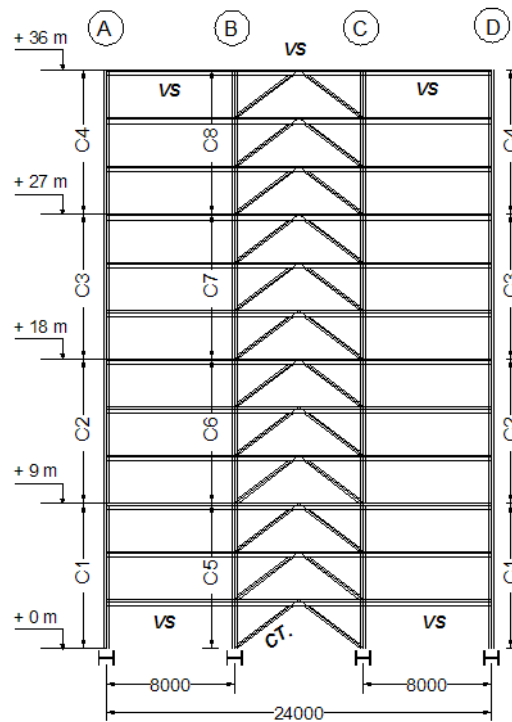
Elevação para os eixos 1,3,5,7 e 9.
